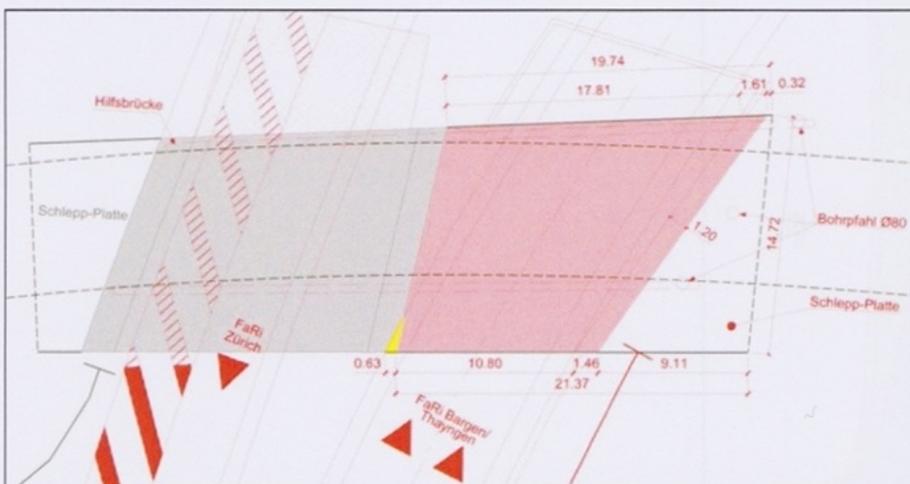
SBB-Überführung, Grundriss
